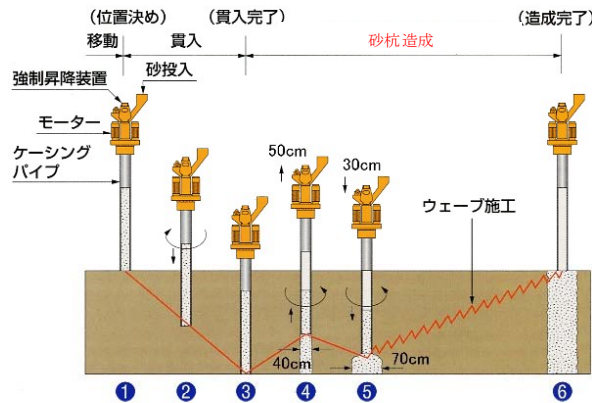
静的締固め砂杭工法(SAVE コンポーザー)の施工サイクル
